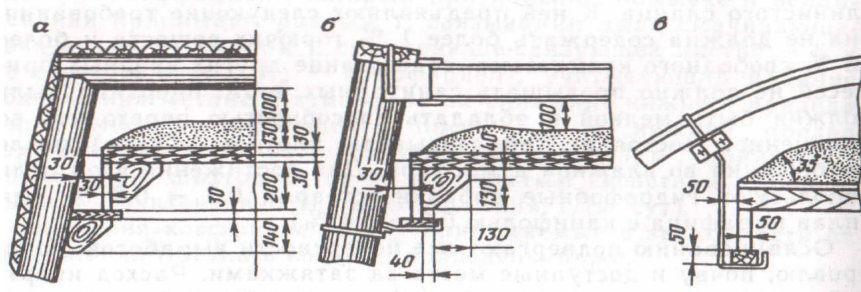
Установка сланцевого заслона в выработках с деревянной крепью (а), железобетонными сетками с шарнирно-подвесными верхняками (б) и стальной арочной крепью (в)
